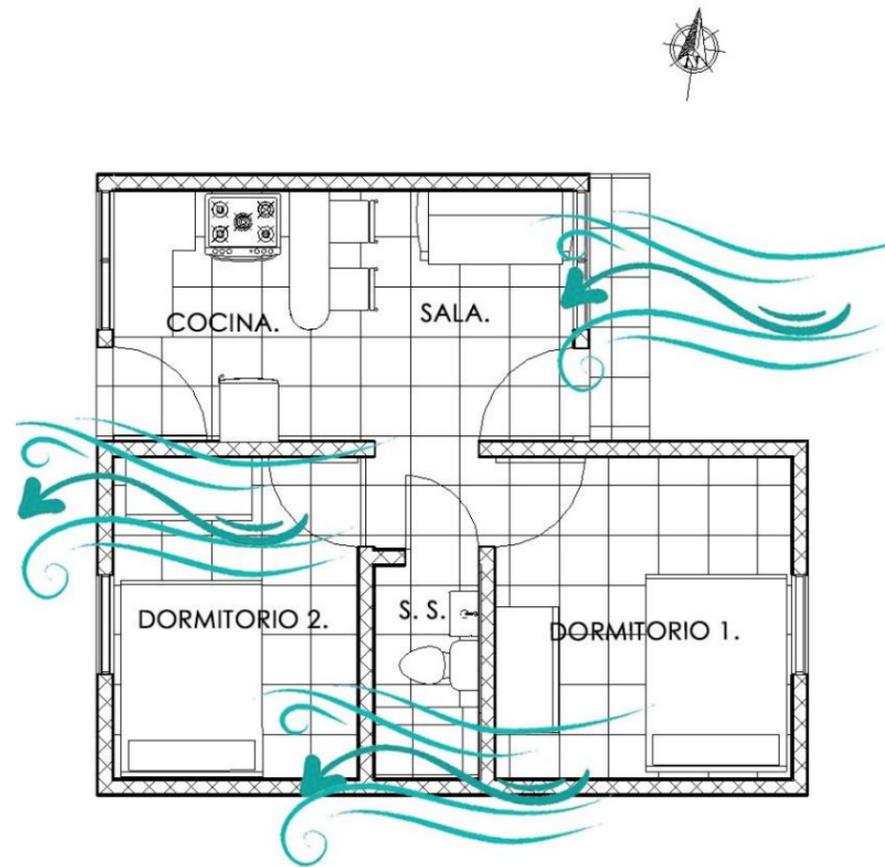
Planta Arquitectónica Vivienda Modelo C-12 con afluencia de ventilación Este.
